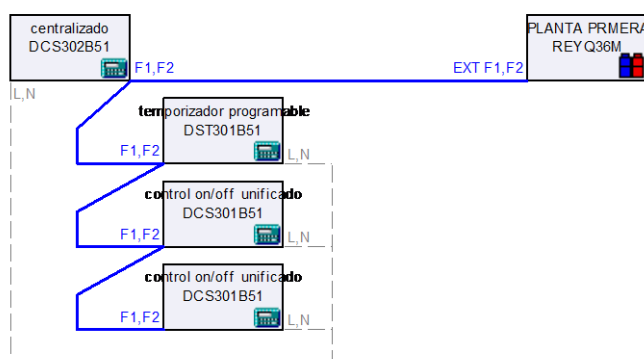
Esquema conexión control centralizado VRV. PLANTA PRIMERA
